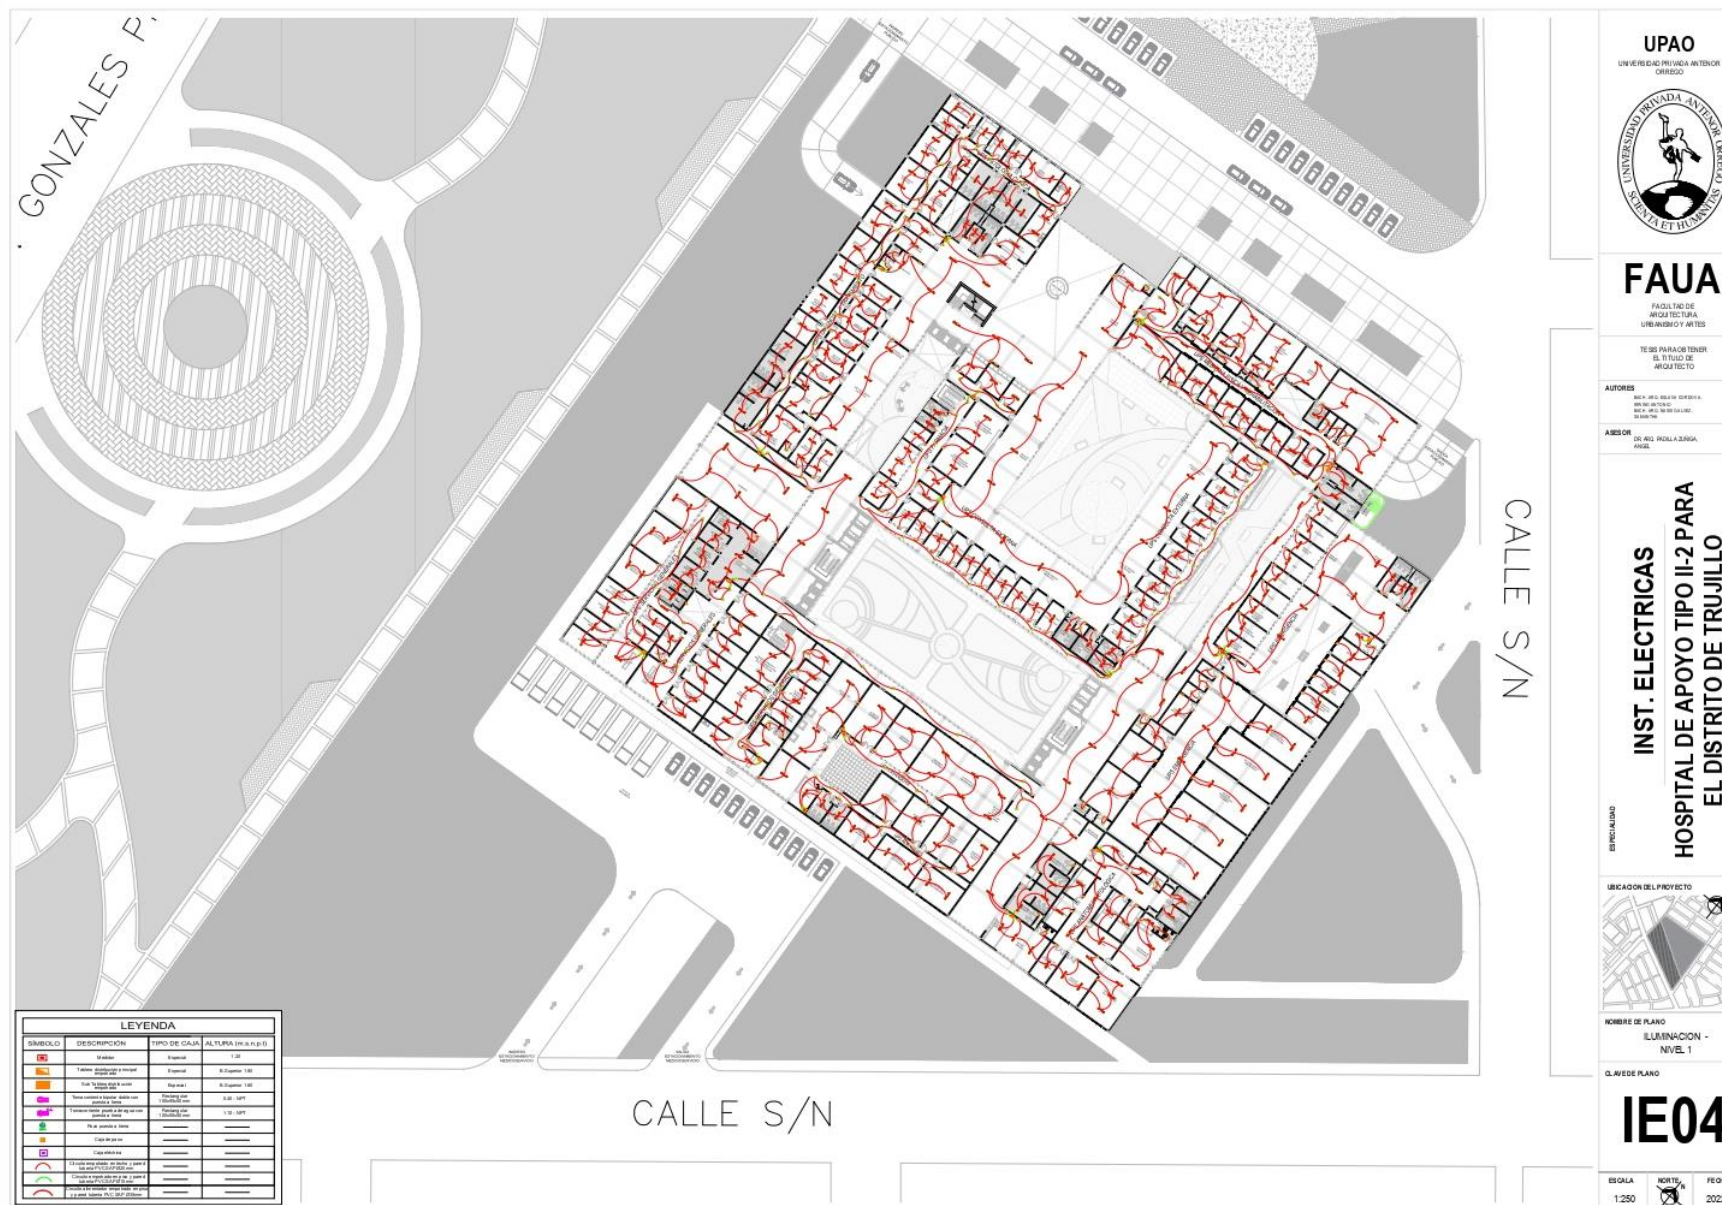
Plano de Instalaciones Eléctricas – Iluminación 1º Nivel. Fuente: Elaboración Propia
